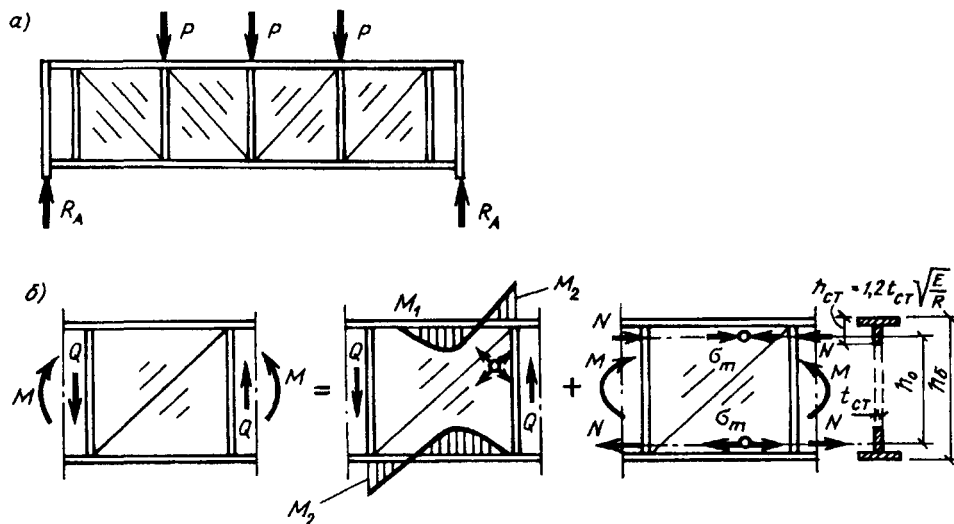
Балка с гибкой стенкой (а) и ее работа под нагрузкой (б)
